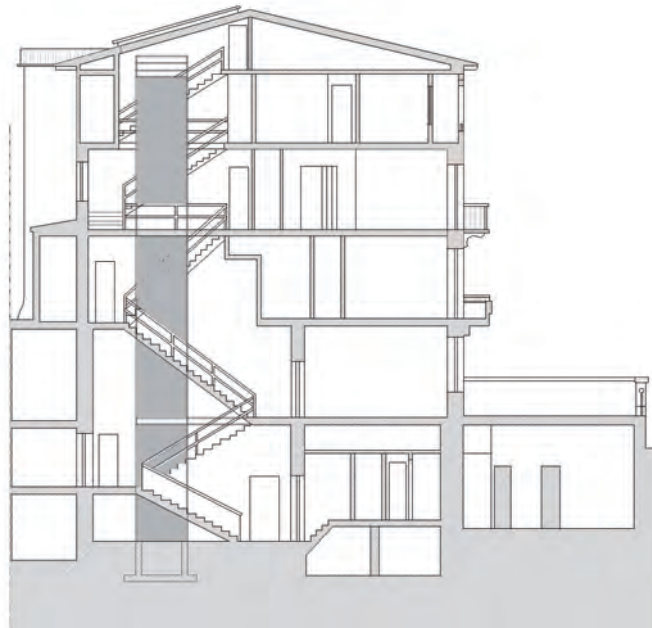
16. SECCIÓN DESDE CAJA DE ESCALERAS
